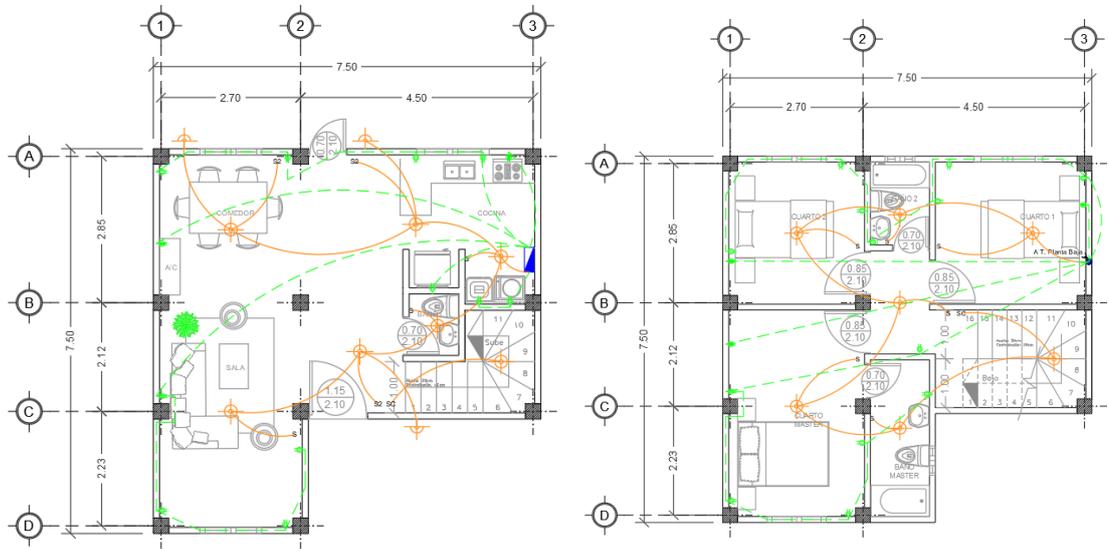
Planos eléctricos casa 1 (elaboración propia)
